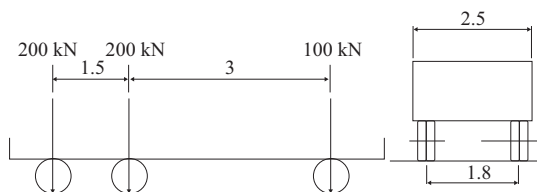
12 m³ 砼罐车荷载布置示意图(单位:m)
